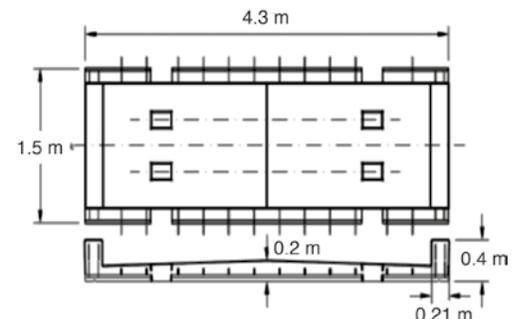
Losa prefabricada de concreto prefabricada típica
